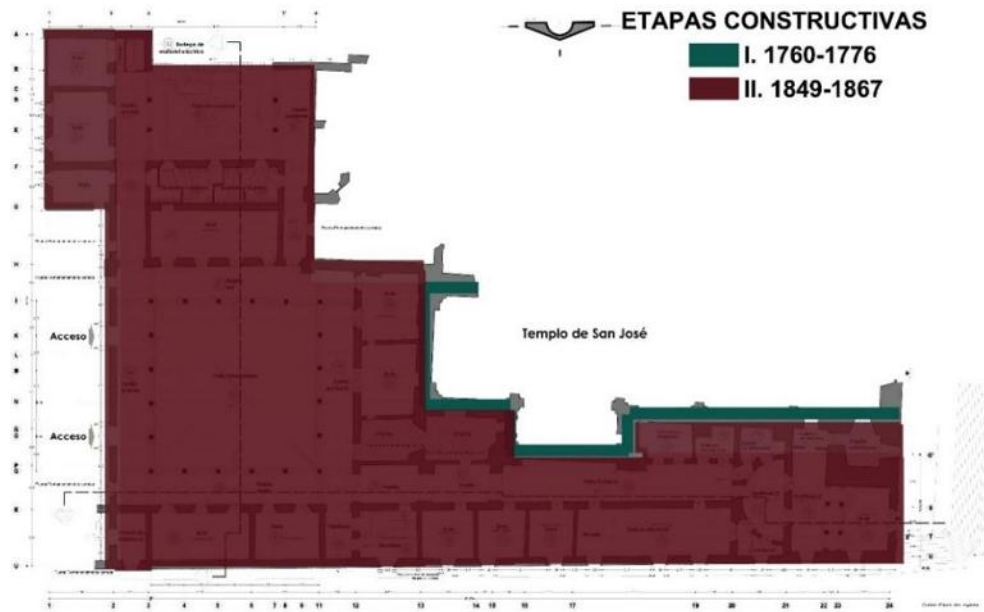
Segunda etapa de construcción (Planta baja)¹²⁸
